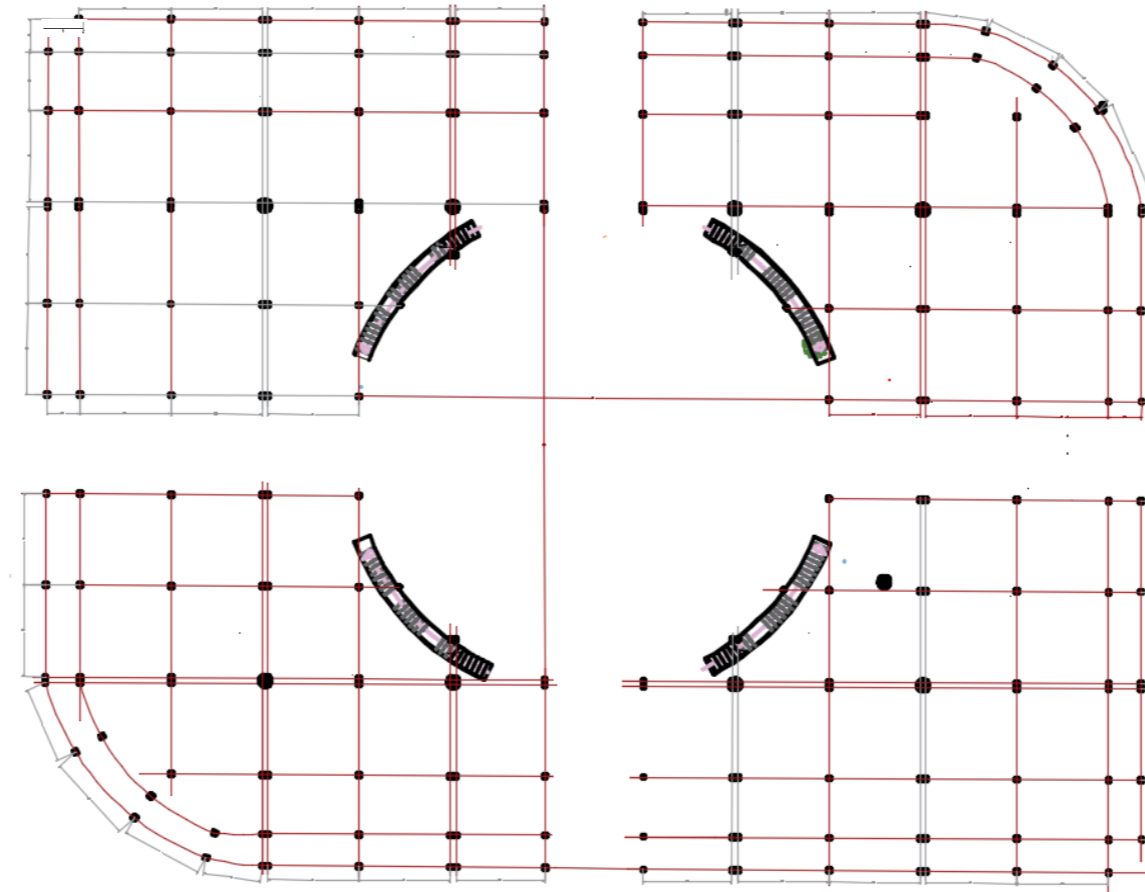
Plan de toiture d'imagerie médicale, Source : Auteur
